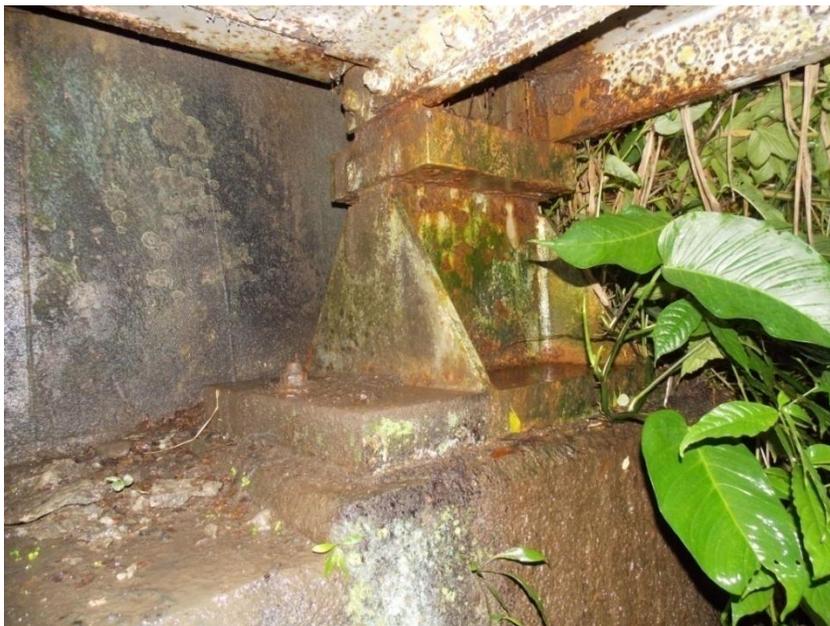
Oxidación y ambiente húmedo en el apoyo fijo sur sobre el bastión 1
